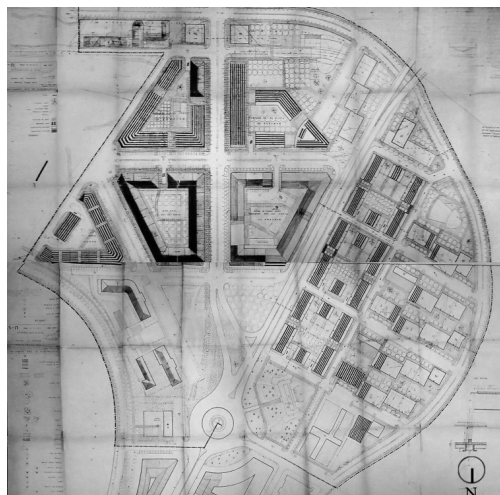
/ ENCÍO CORTÁZAR, Juan Manuel. Plan Parcial del Sector 1.3 Ensanche de Amara. 1963-1966
